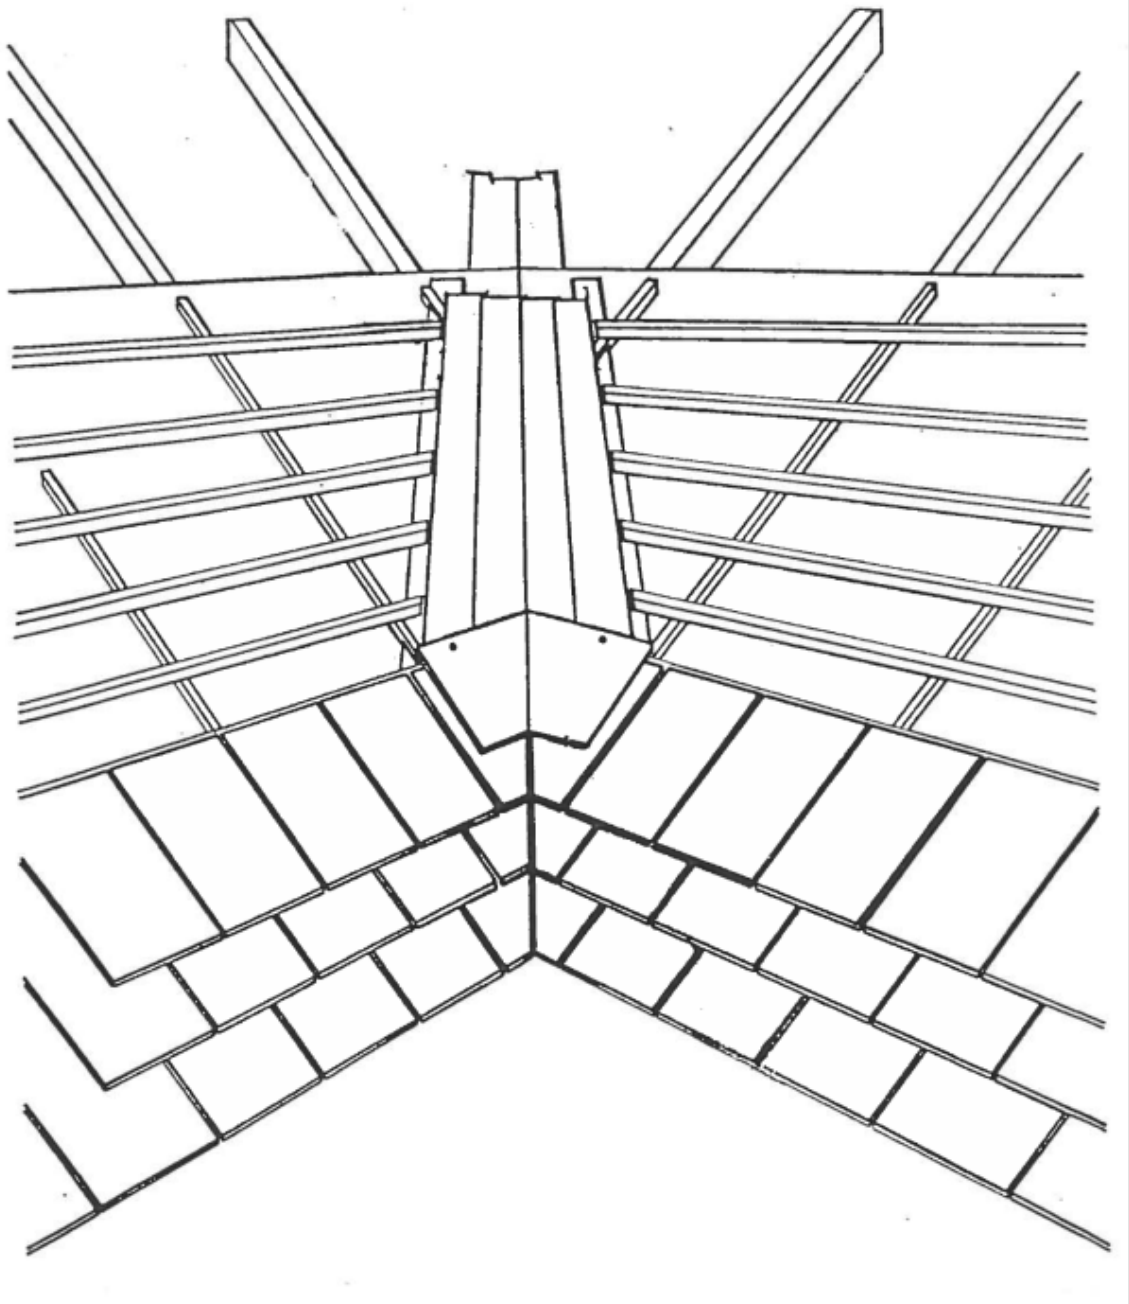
Doorsnede hoekkeperafwerking Duitse hoek
